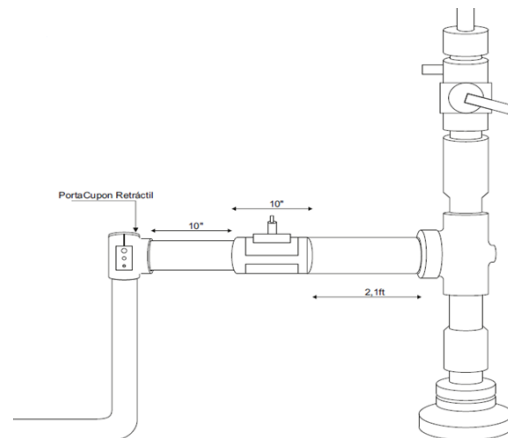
Diseño Pozo: T-103. Fuente: Los autores.
